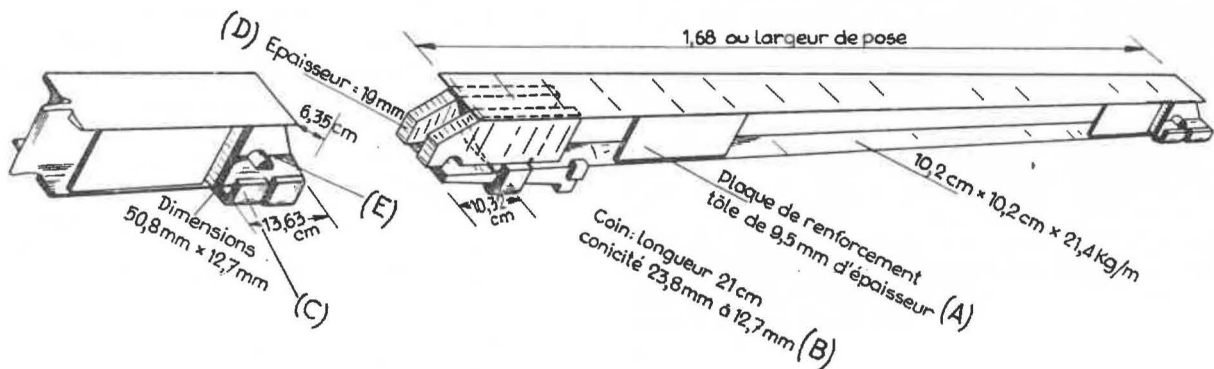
Construction du chapeau de toit en acier Hanman.
